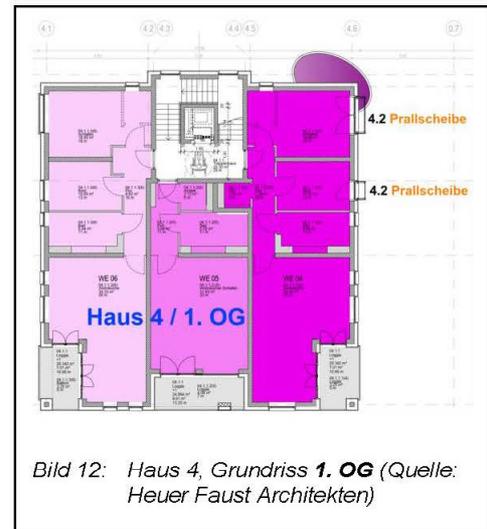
Haus 4, Grundriss 1. OG (Quelle: Heuer Faust Architekten)
